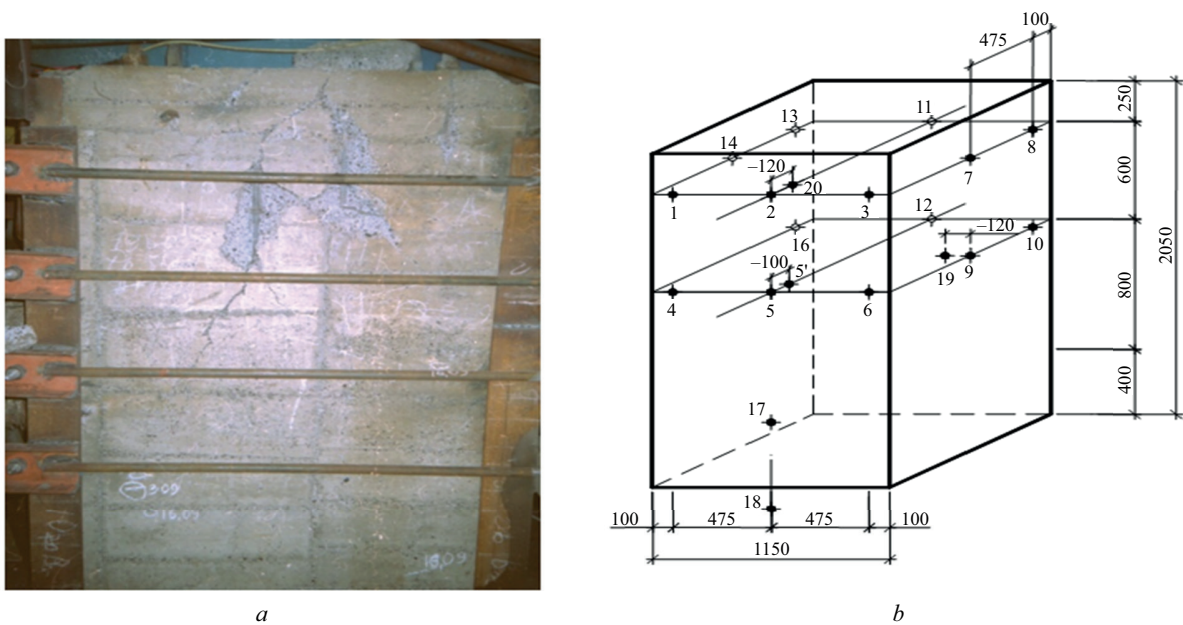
Конструкция столбчатого фундамента с повреждениями (а) и схема расположения ХК-термопар (b) МНЛЗ ЕМЗ ООО «ЮГМК» г. Енакиево
